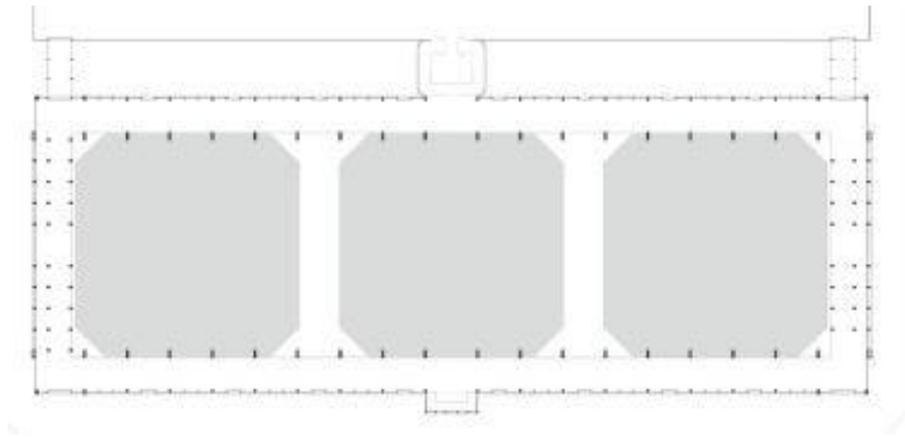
Comparación de la superficie entre el pabellón de la Galería de las Máquinas y las manzanas del ensanche de Barcelona de Cerdà. (Linares de la Torre, 2018)
